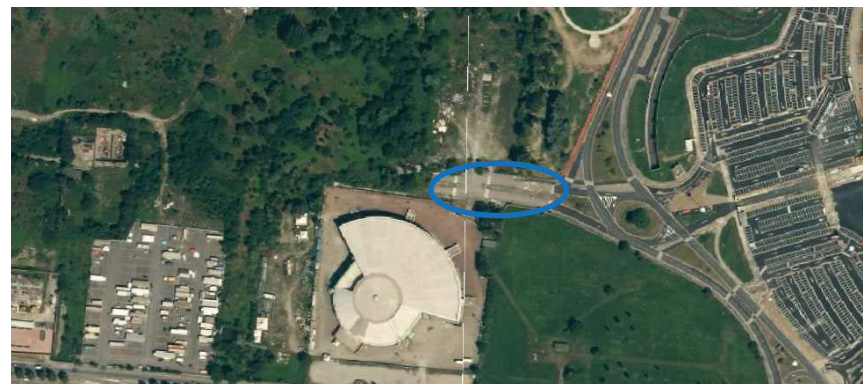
Stato attuale - Foto Aerea - Cerchiata in blu la viabilità esistente che ricade all'interno della zona di rispetto ristretta dei pozzi SMAT
